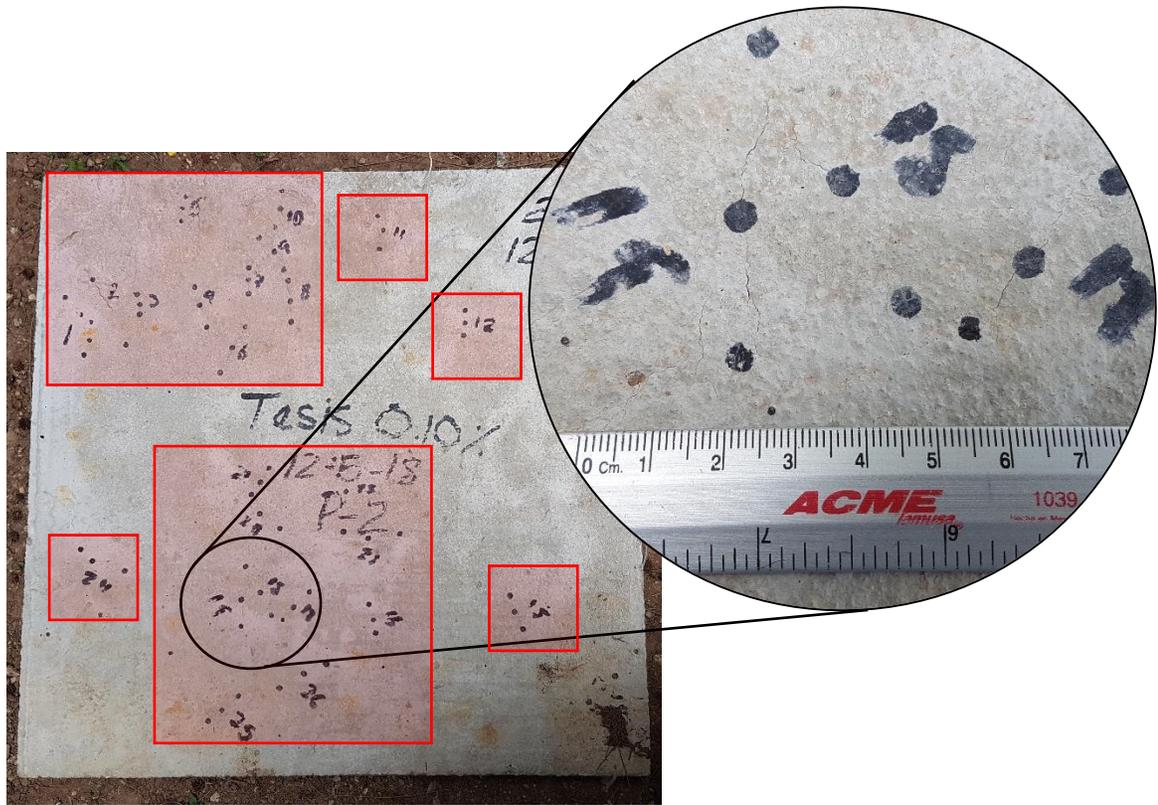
Losa CONCREPET con 0.10% de fibra, 50% fisurada a 21 días
